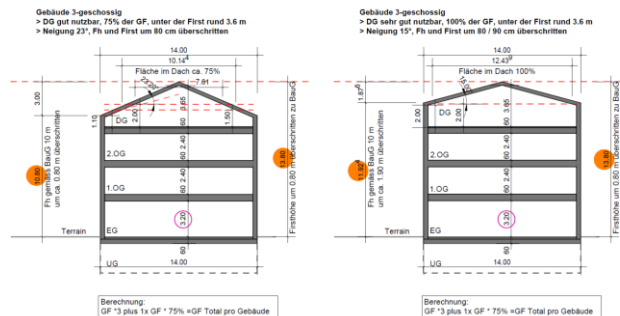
Schnitte zur Untersuchung der Gebäude- und Fassadenhöhe
